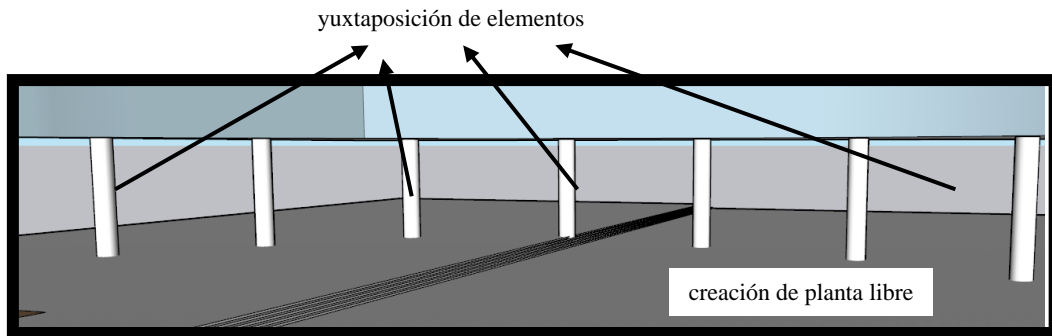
Vista de planta libre estación de bomberos. Elaboración propia
